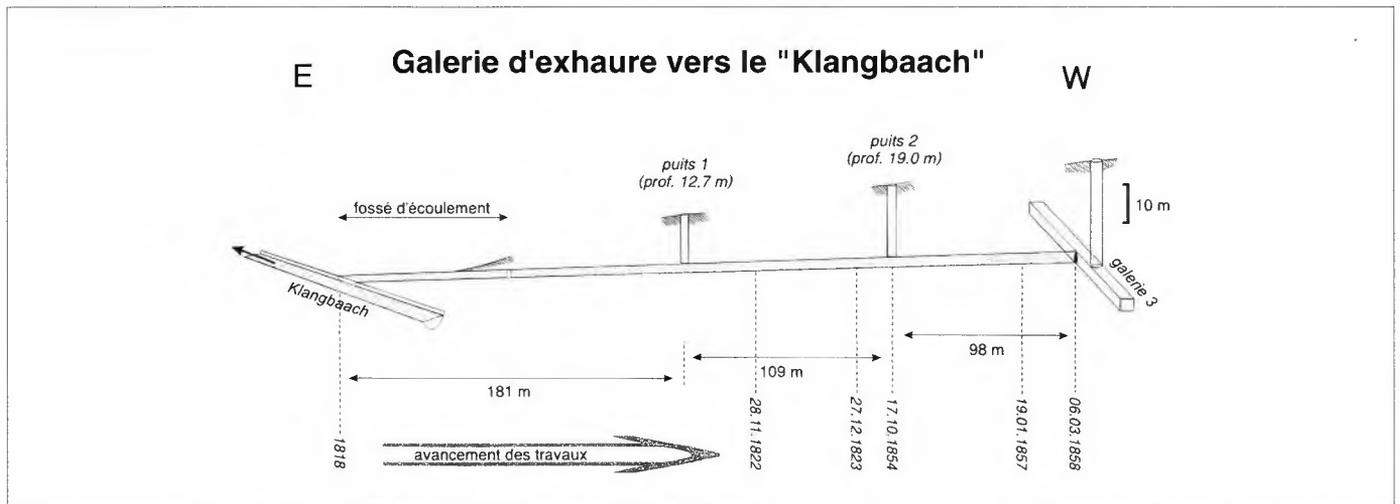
Der langwierige Bau des Entwässerungsstollen, Galerie 2.
